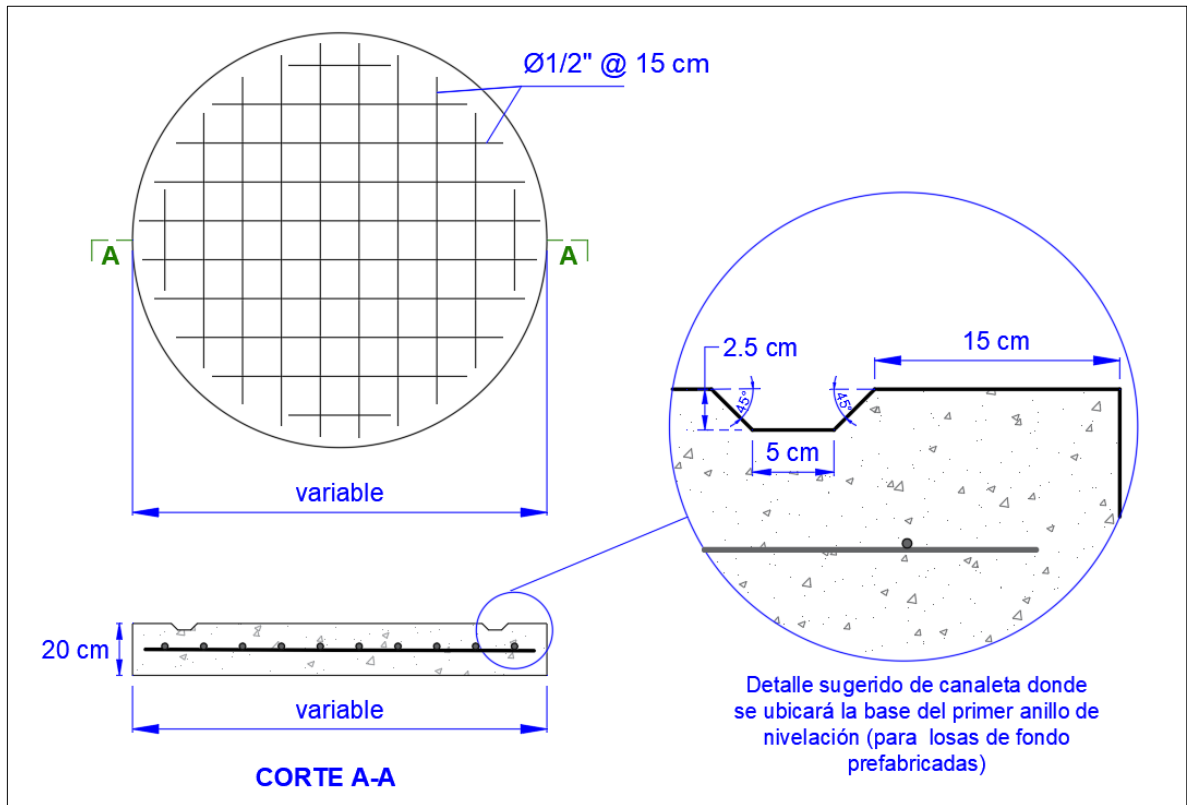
Disposición mínima de la capa de armadura de la losa de fondo, y diseño sugerido de la canaleta (para losas de fondo prefabricadas) donde se construirá *in situ* el primer anillo de nivelación.
